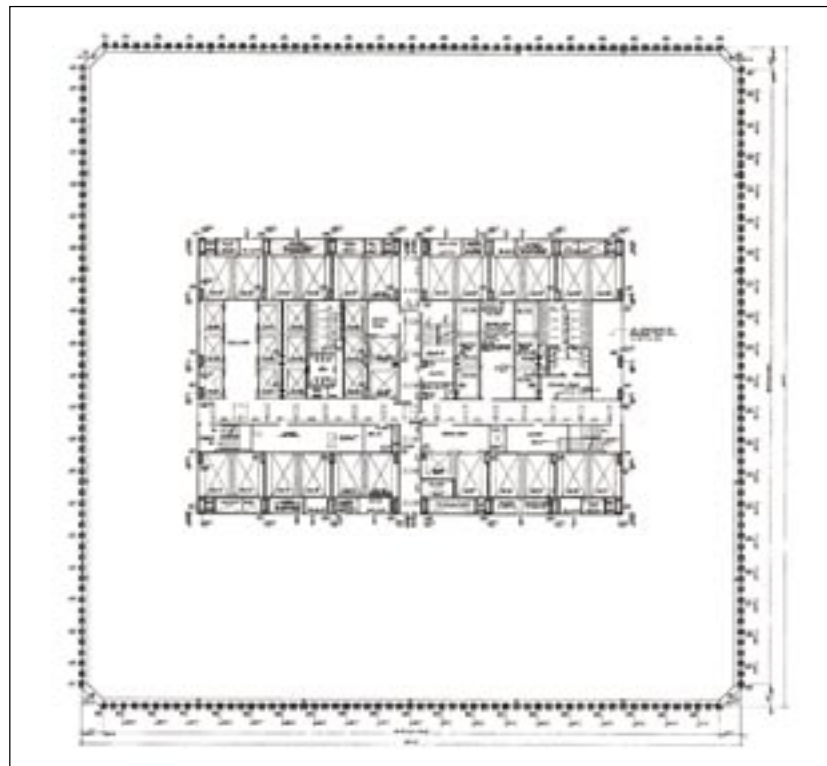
Зона центрального ствола в типовом плане межэтажного перекрытия ВТЦ-1 и ВТЦ-2
